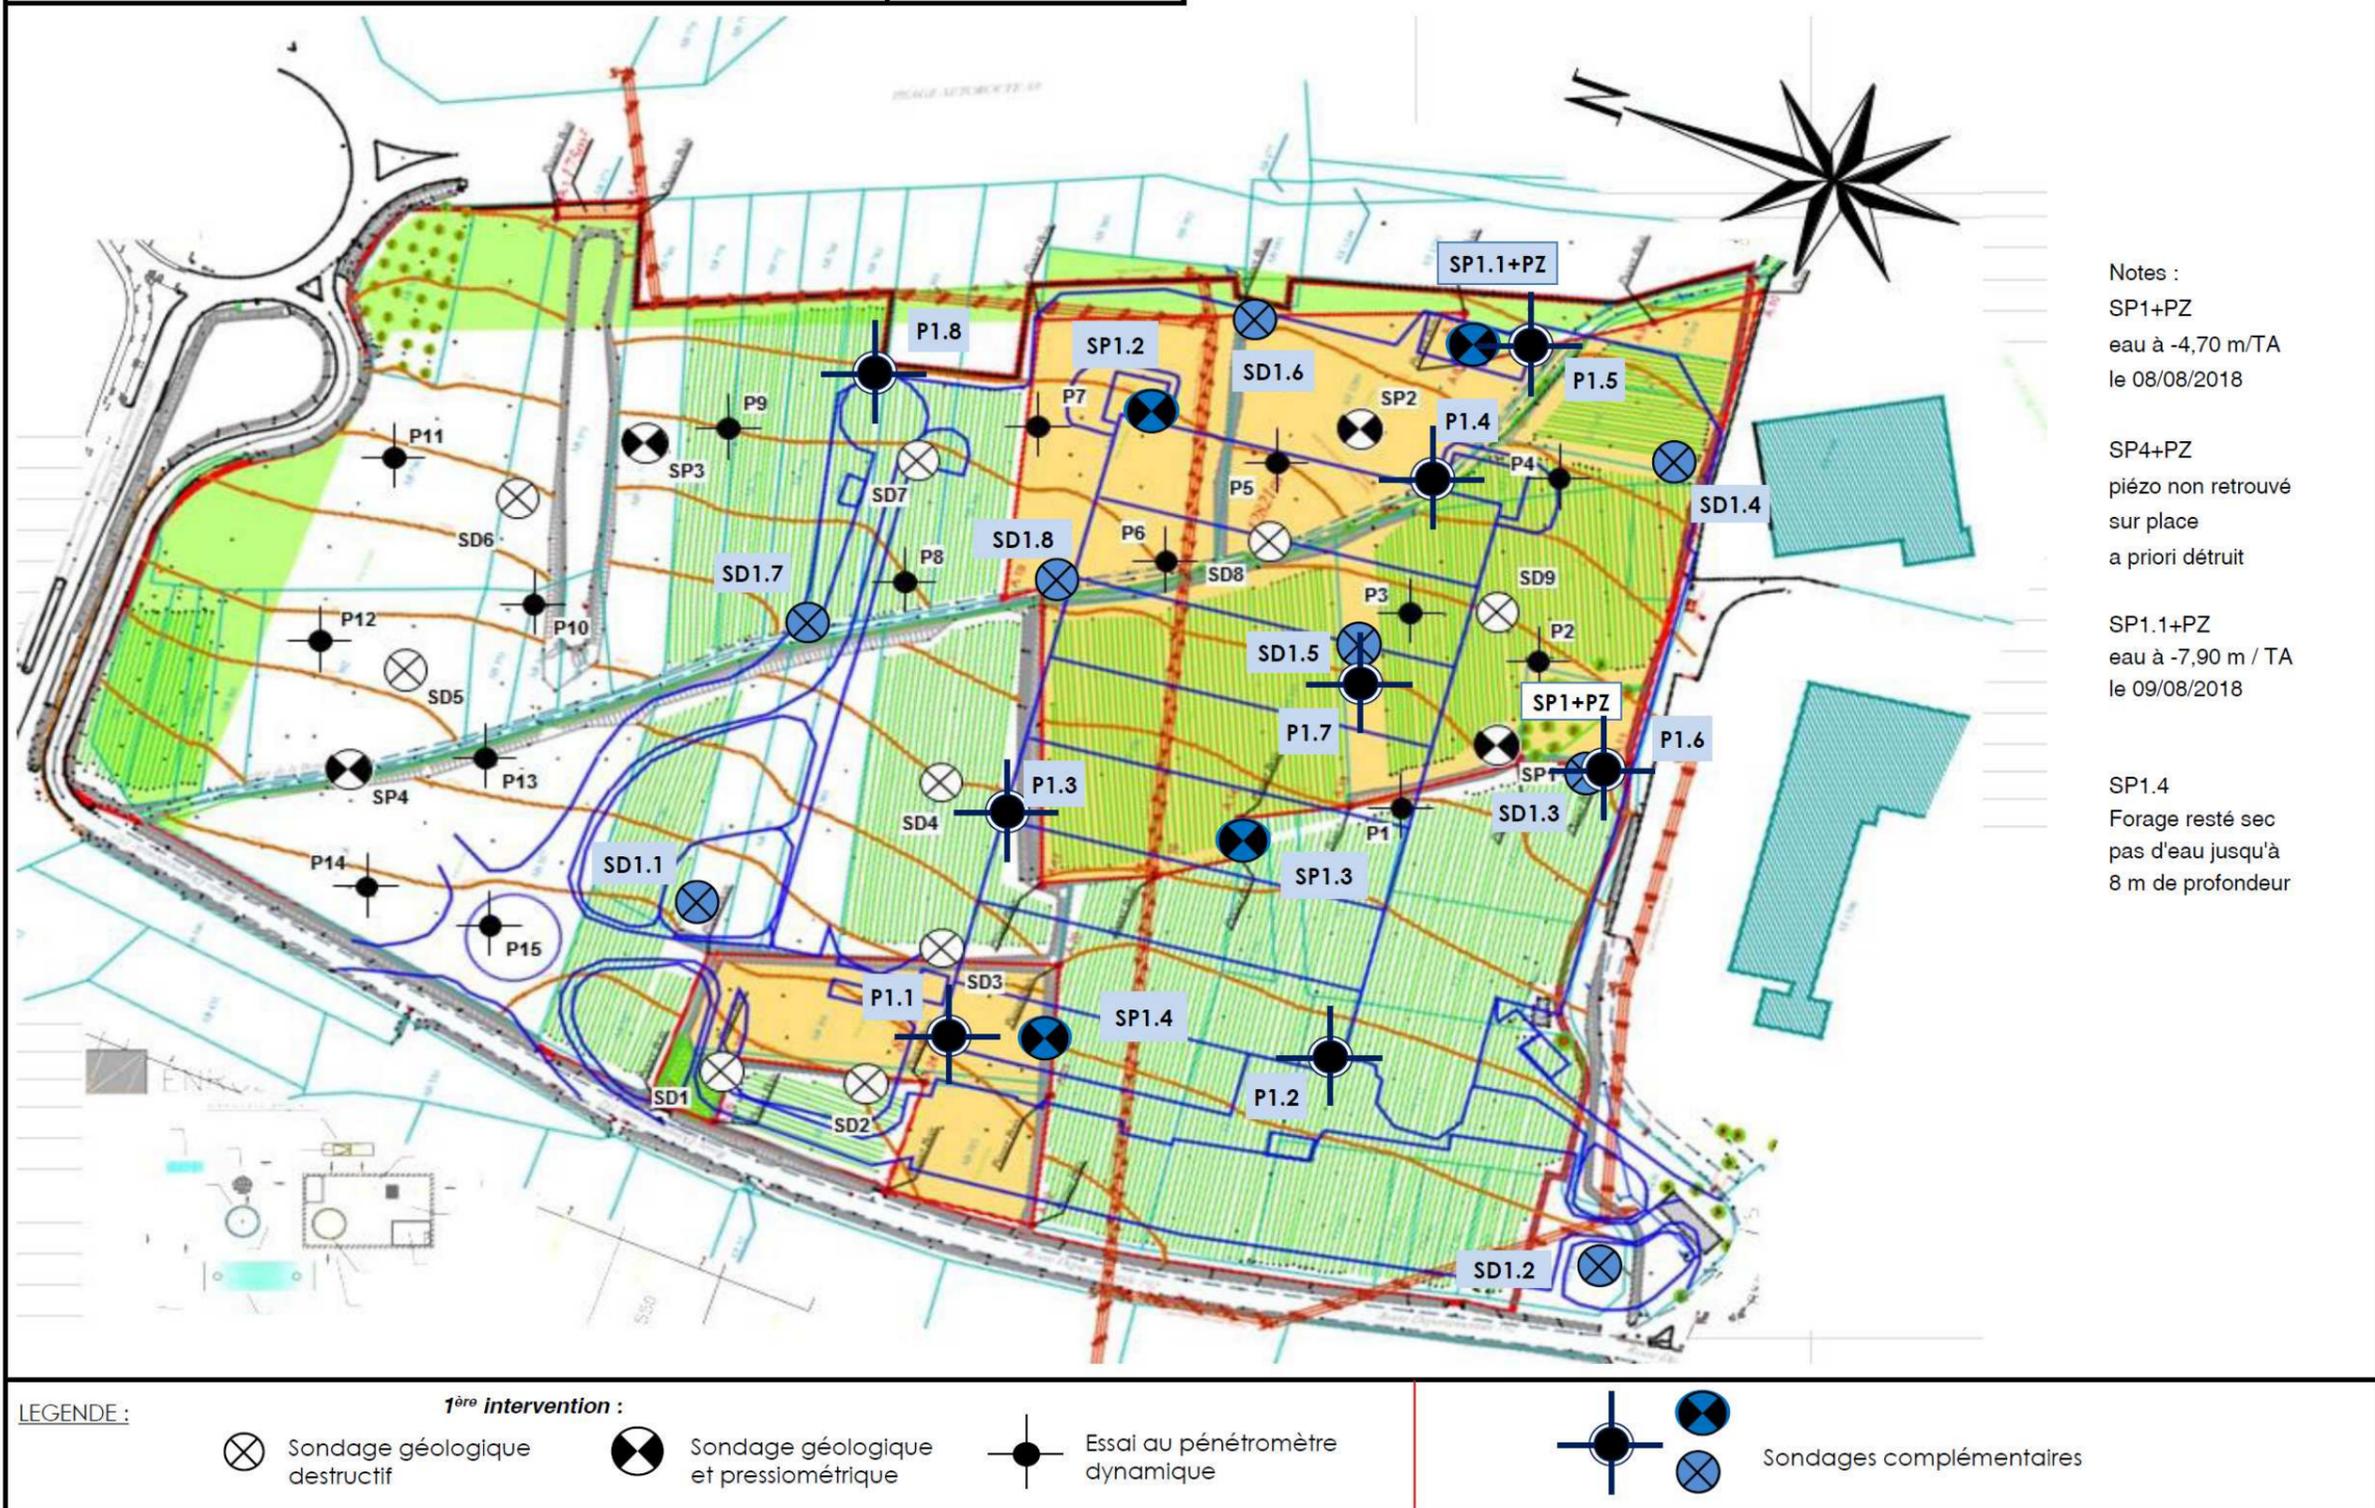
Plan d'implantation des piézomètres (Source : Fondatec)
